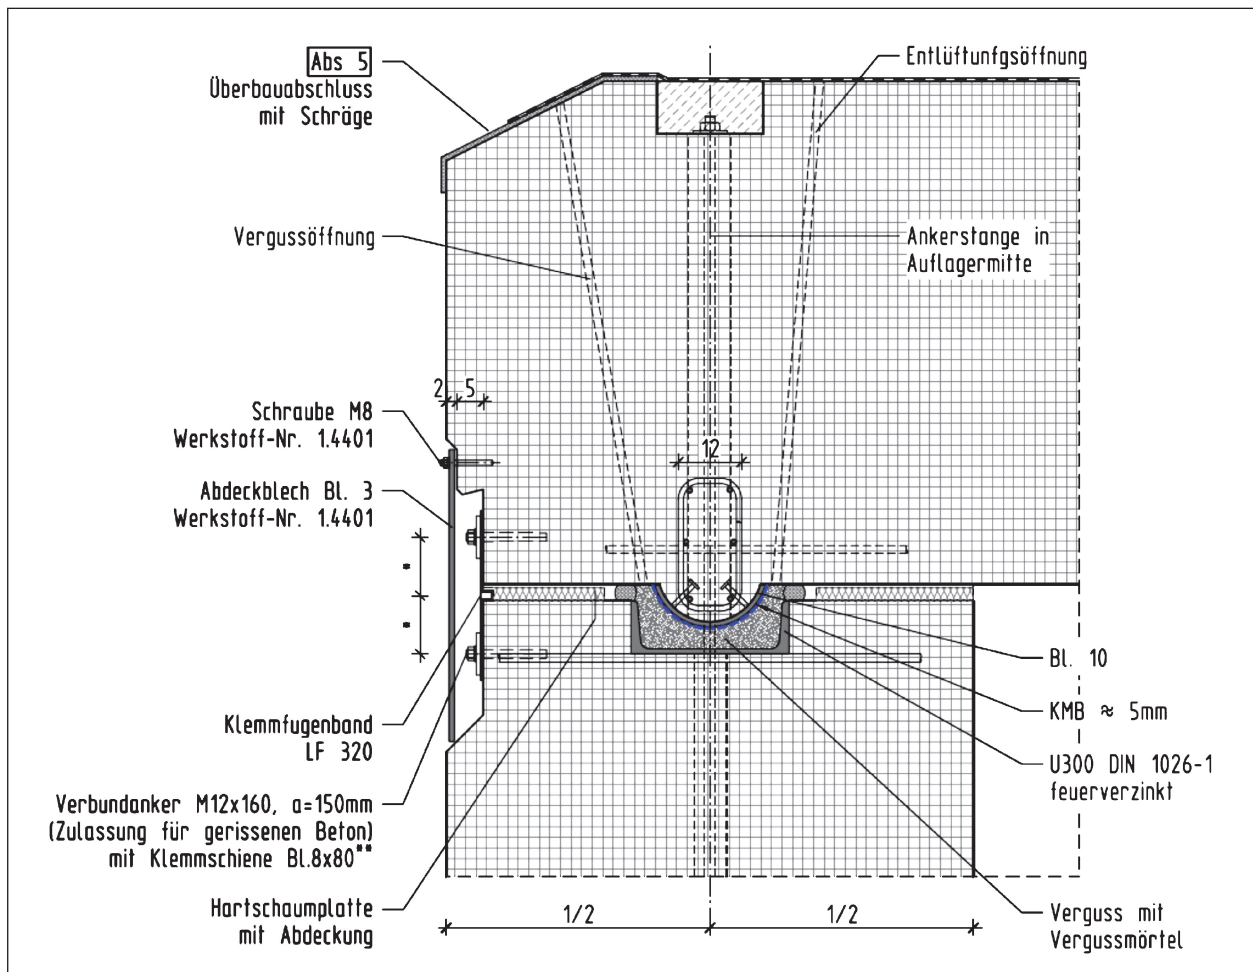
Detail – Betongelenk und Überbauabschluss
